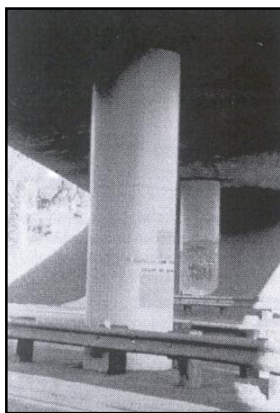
Detalhe da ligação do reforço no pilar à fundação (SOUSA, 2008).
